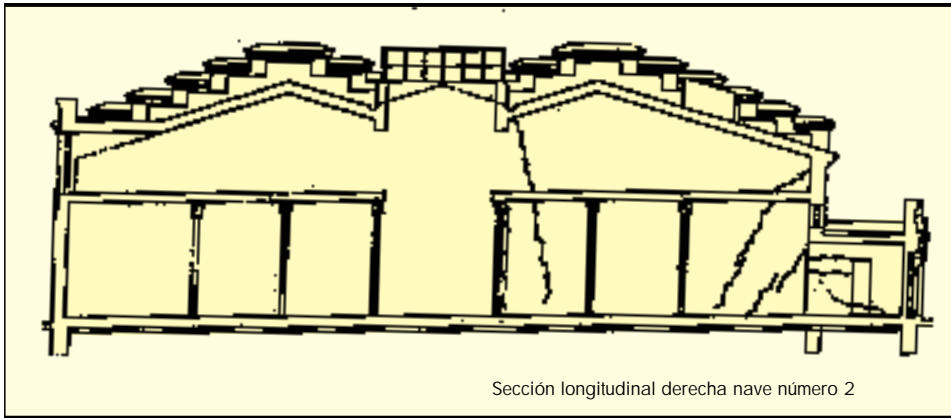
Croquis de fisuración de muros principales.
